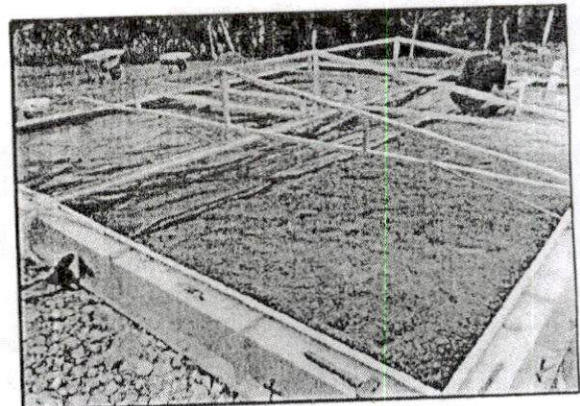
Aterro no interior da forma e colocação da lona plástica.
